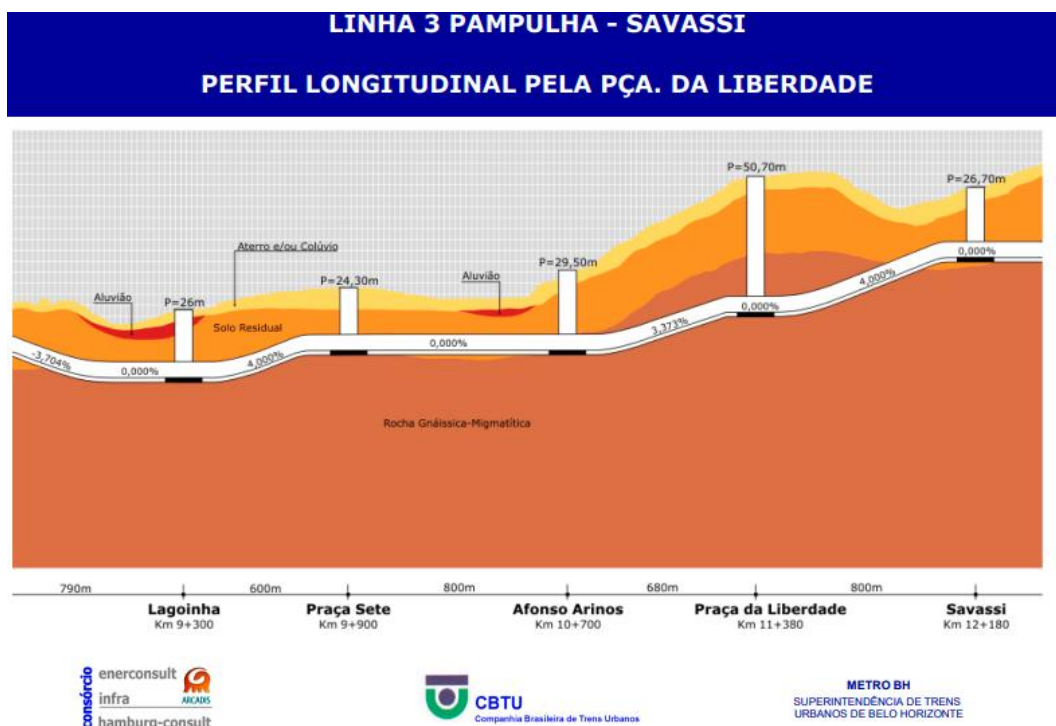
Perfil longitudinal da Linha 3, da estação Lagoinha a estação Savassi pela Avenida João Pinheiro
